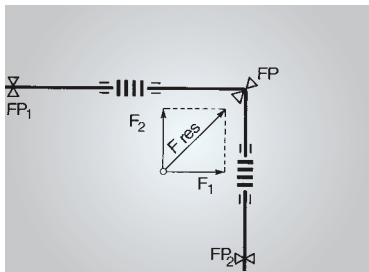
Abgewinkeltes System mit Axial-Kompensatoren und Kniefestpunkt
